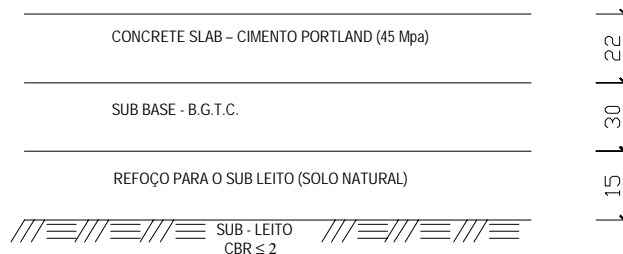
Camadas de Pavimento da Canaleta Exclusiva para Ônibus
